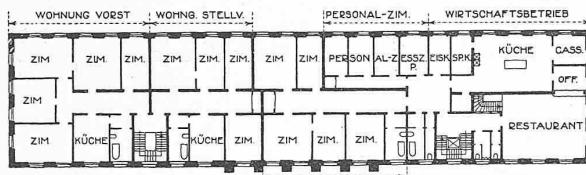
und 19. Grundrisse des Aufnahmegebäudes. — 1:800.
